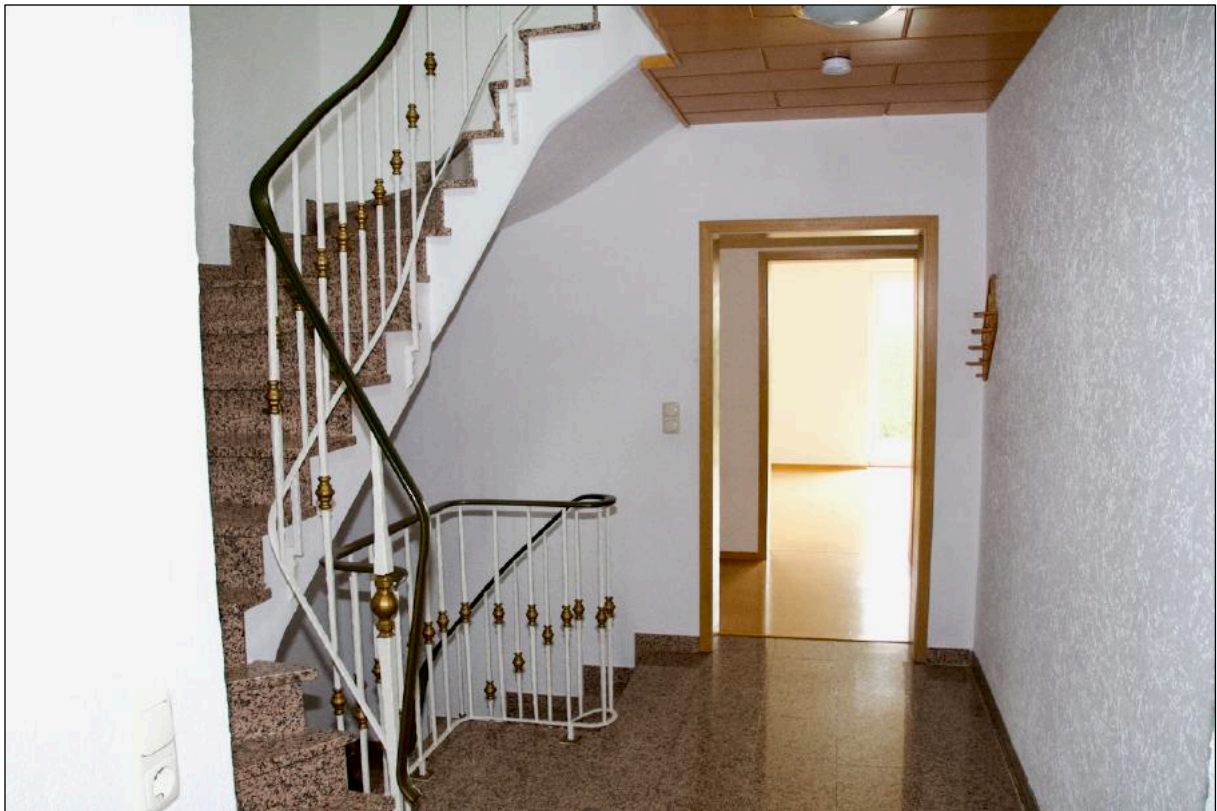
Erdgeschoss - Eingangsbereich, Treppenhaus
